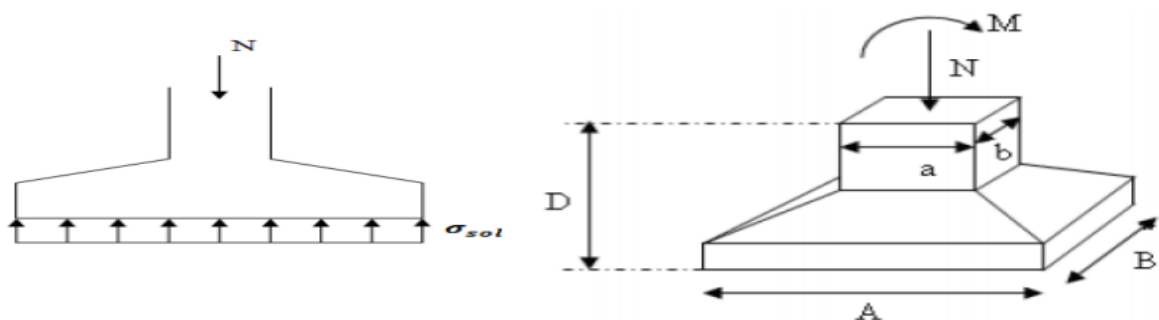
Schéma des Semelles isolée sous poteaux.
